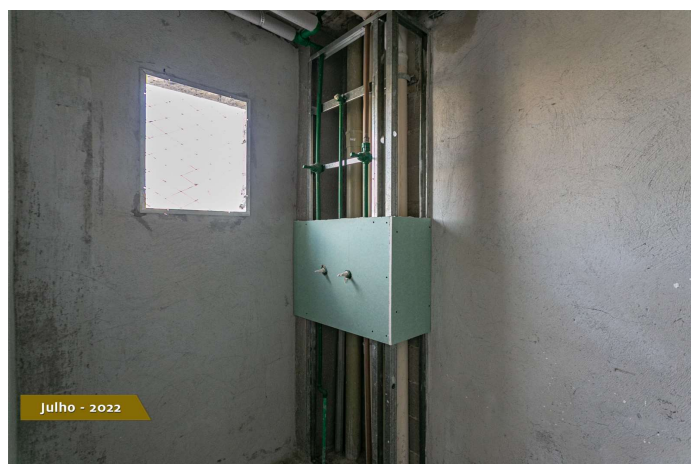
Instalações Elétricas e Tubulações em unidade.
